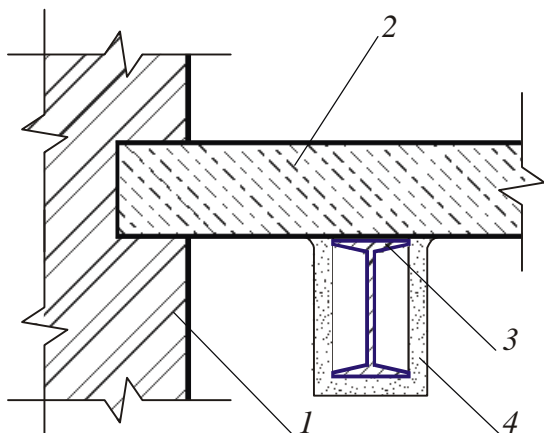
Устранение прогиба плиты перекрытия подведением стальной балки:
